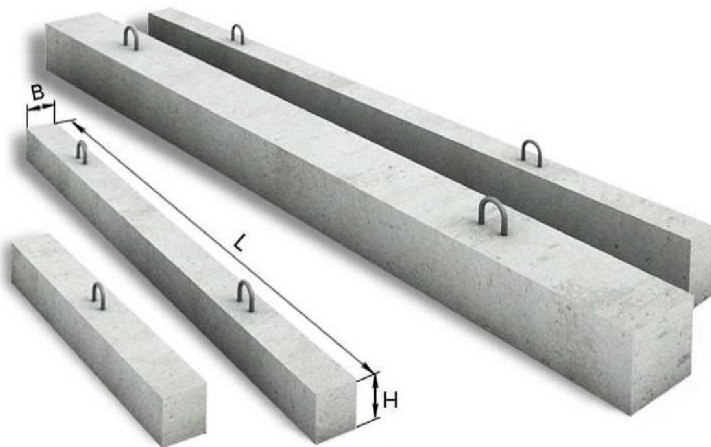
Железобетонные балки прямоугольного сечения [26]
